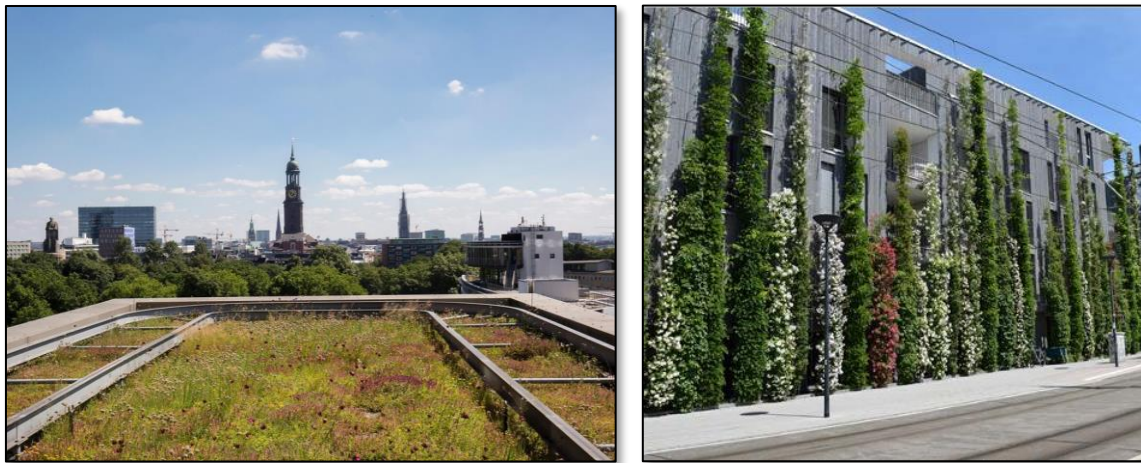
Exemples d'un toit végétalisé (gauche) et d'une façade végétalisée (droite) à Hambourg - Source : (Stadt Hamburg, 2024)
